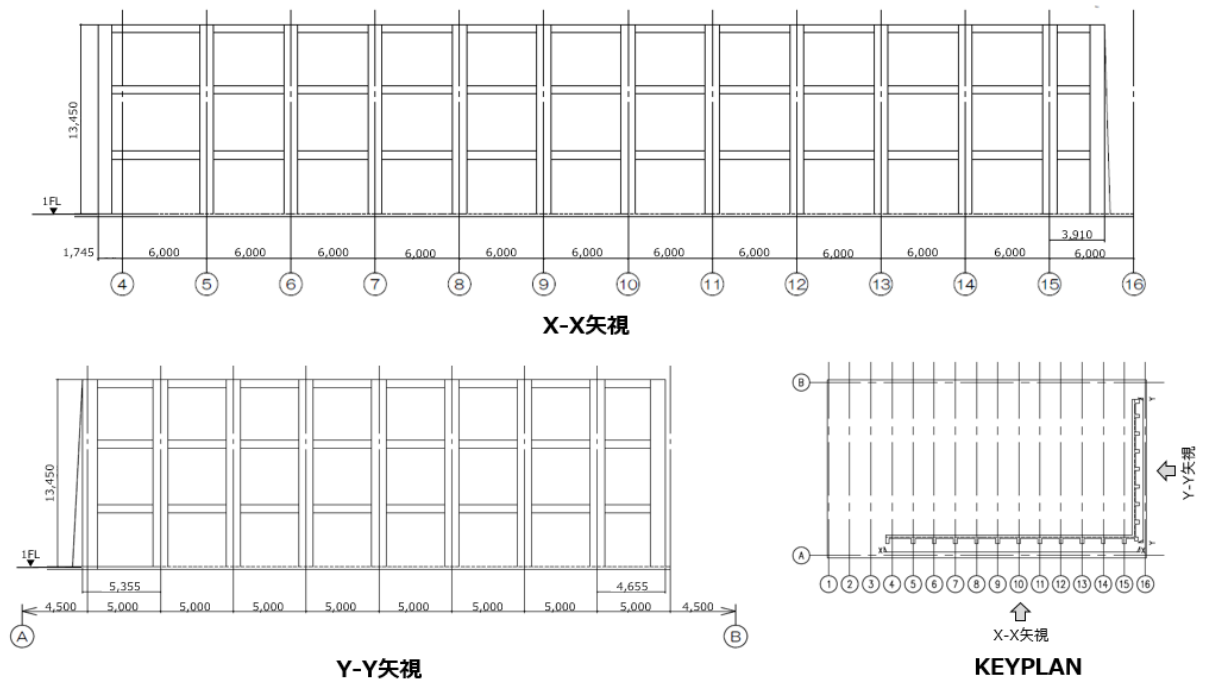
遮蔽壁の立面図 (10-A, B 貯蔵庫)
